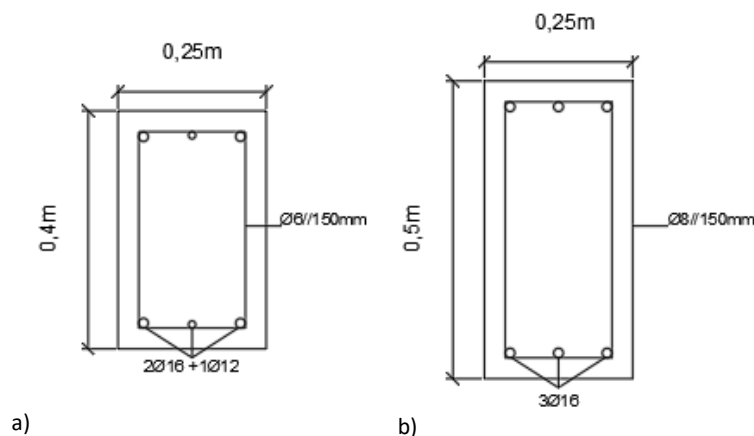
Seções transversais a) seção transversal do pilar, b) seção transversal da viga.
